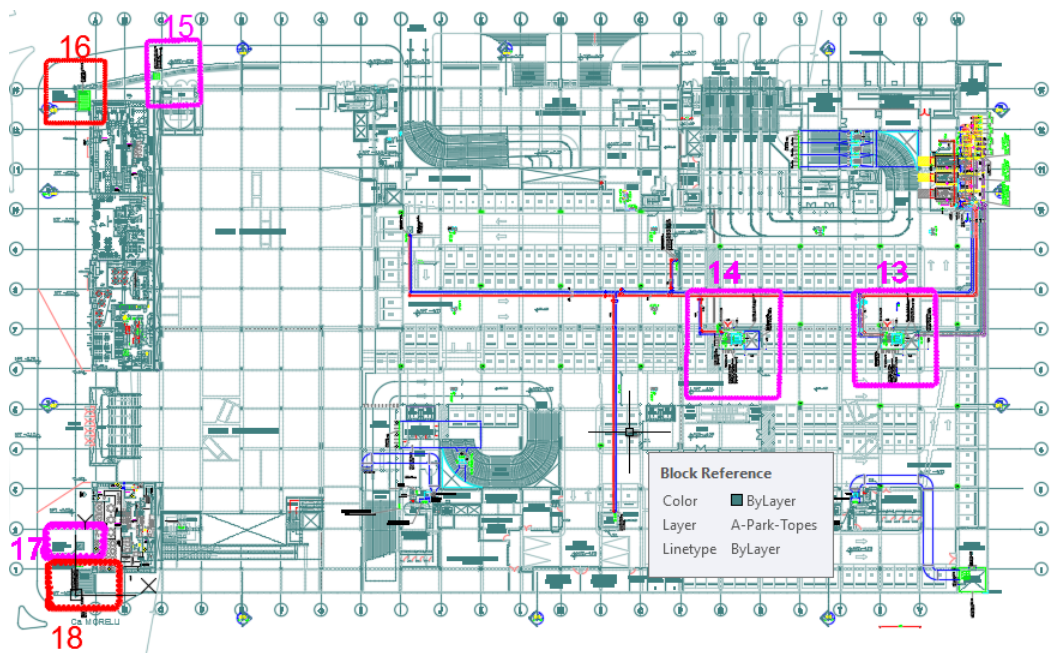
PLANTA GENERAL 2º SÓTANO
